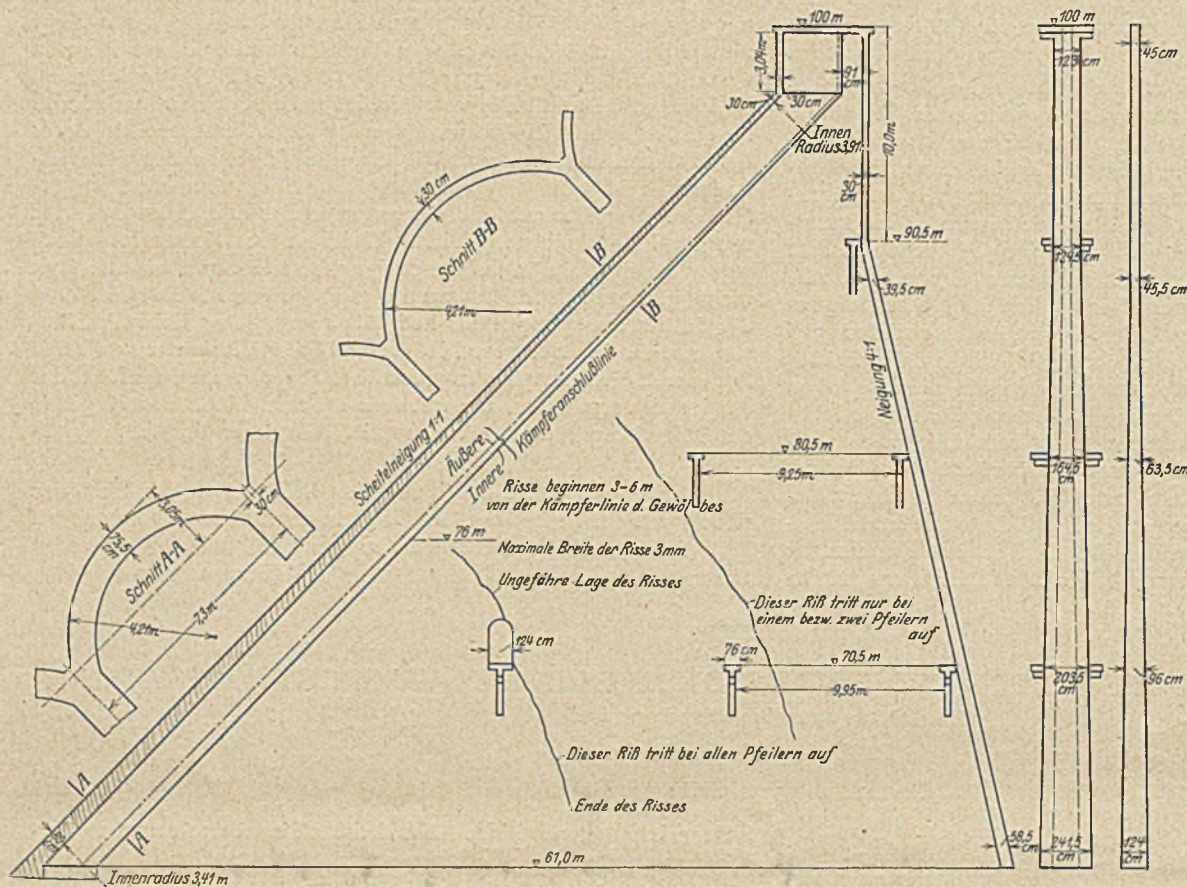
e. RiBbildungen in den Pfeilern einer Eisenbetontalsperre.
